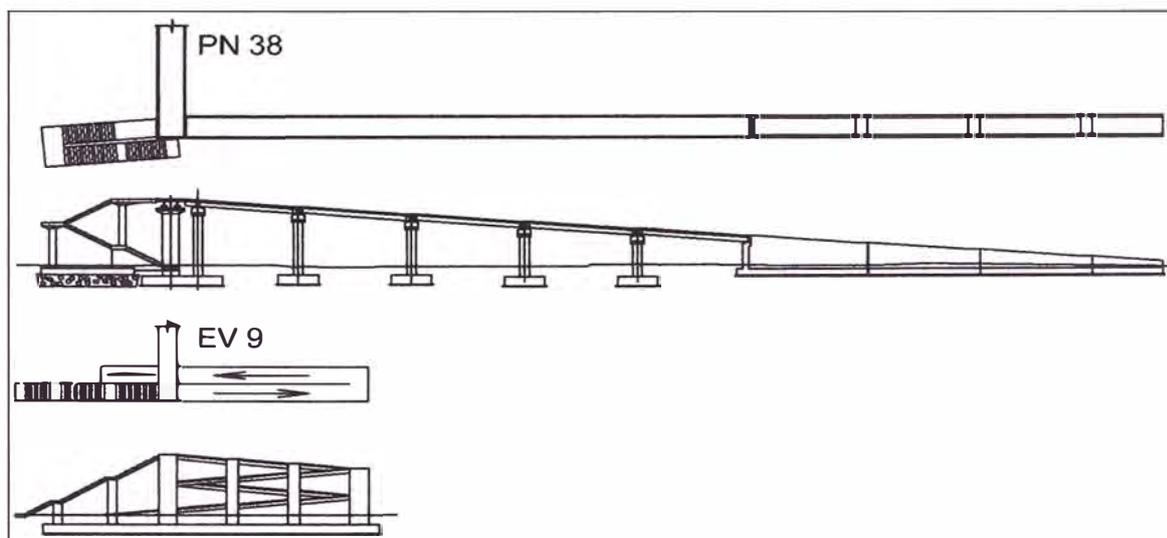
Puentes con rampa de tramos largos y tramos paralelos, con escaleras
